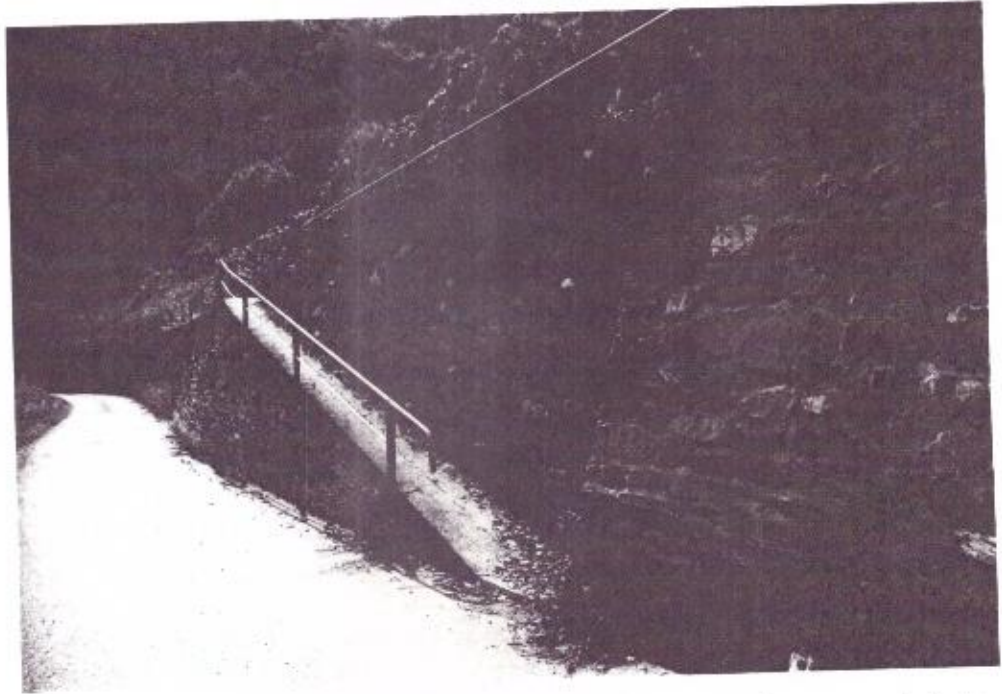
Rampe an einer errichteten Schwergewichtsmauer zur Begehung des Mauerwerkes
